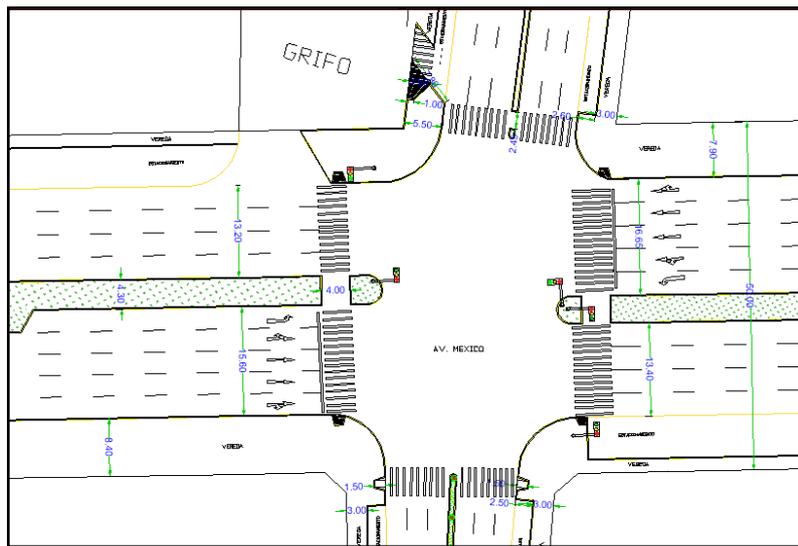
Vista en planta de situación actual del cruce Av. México con la Av. Parinacochas
